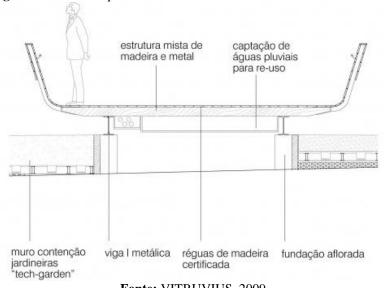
Corte esquemático do Deck de madeira com estrutura metálica
